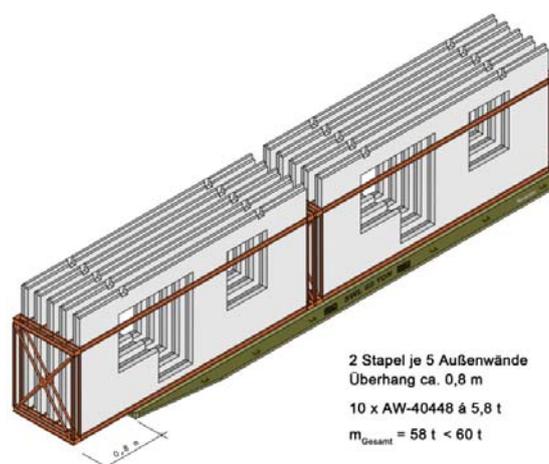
Variante der Beladung eines 40'RoRo-Trailers mit 10 Außenwänden (L: 6,00 m) mit Überhang; Darstellung ohne Ladungssicherung
